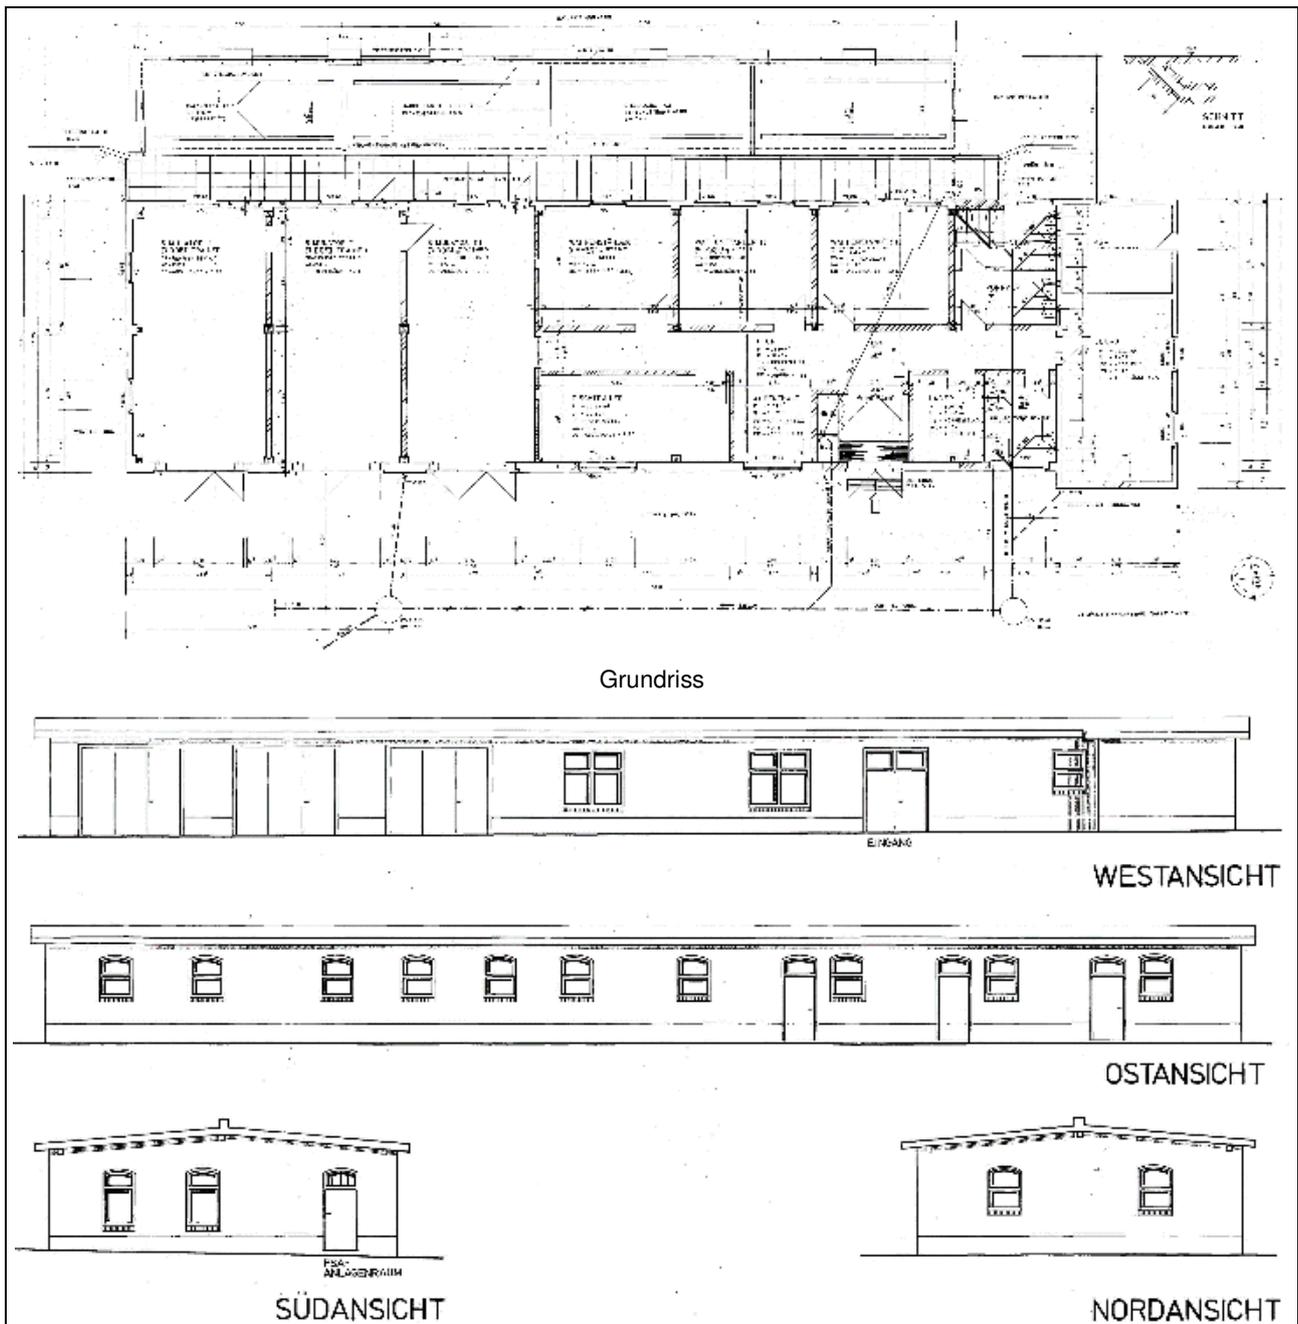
CRE-Garagen / Warrior-Trainer [41] (Grundriss, Ansichten) (Quelle: BIMA Münster)
